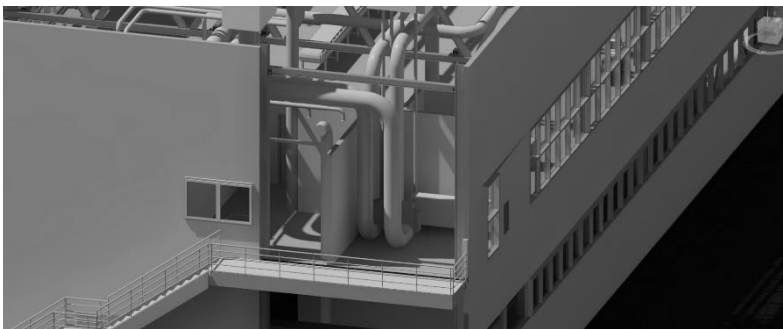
3-D модель производственного корпуса с инженерными сетями
